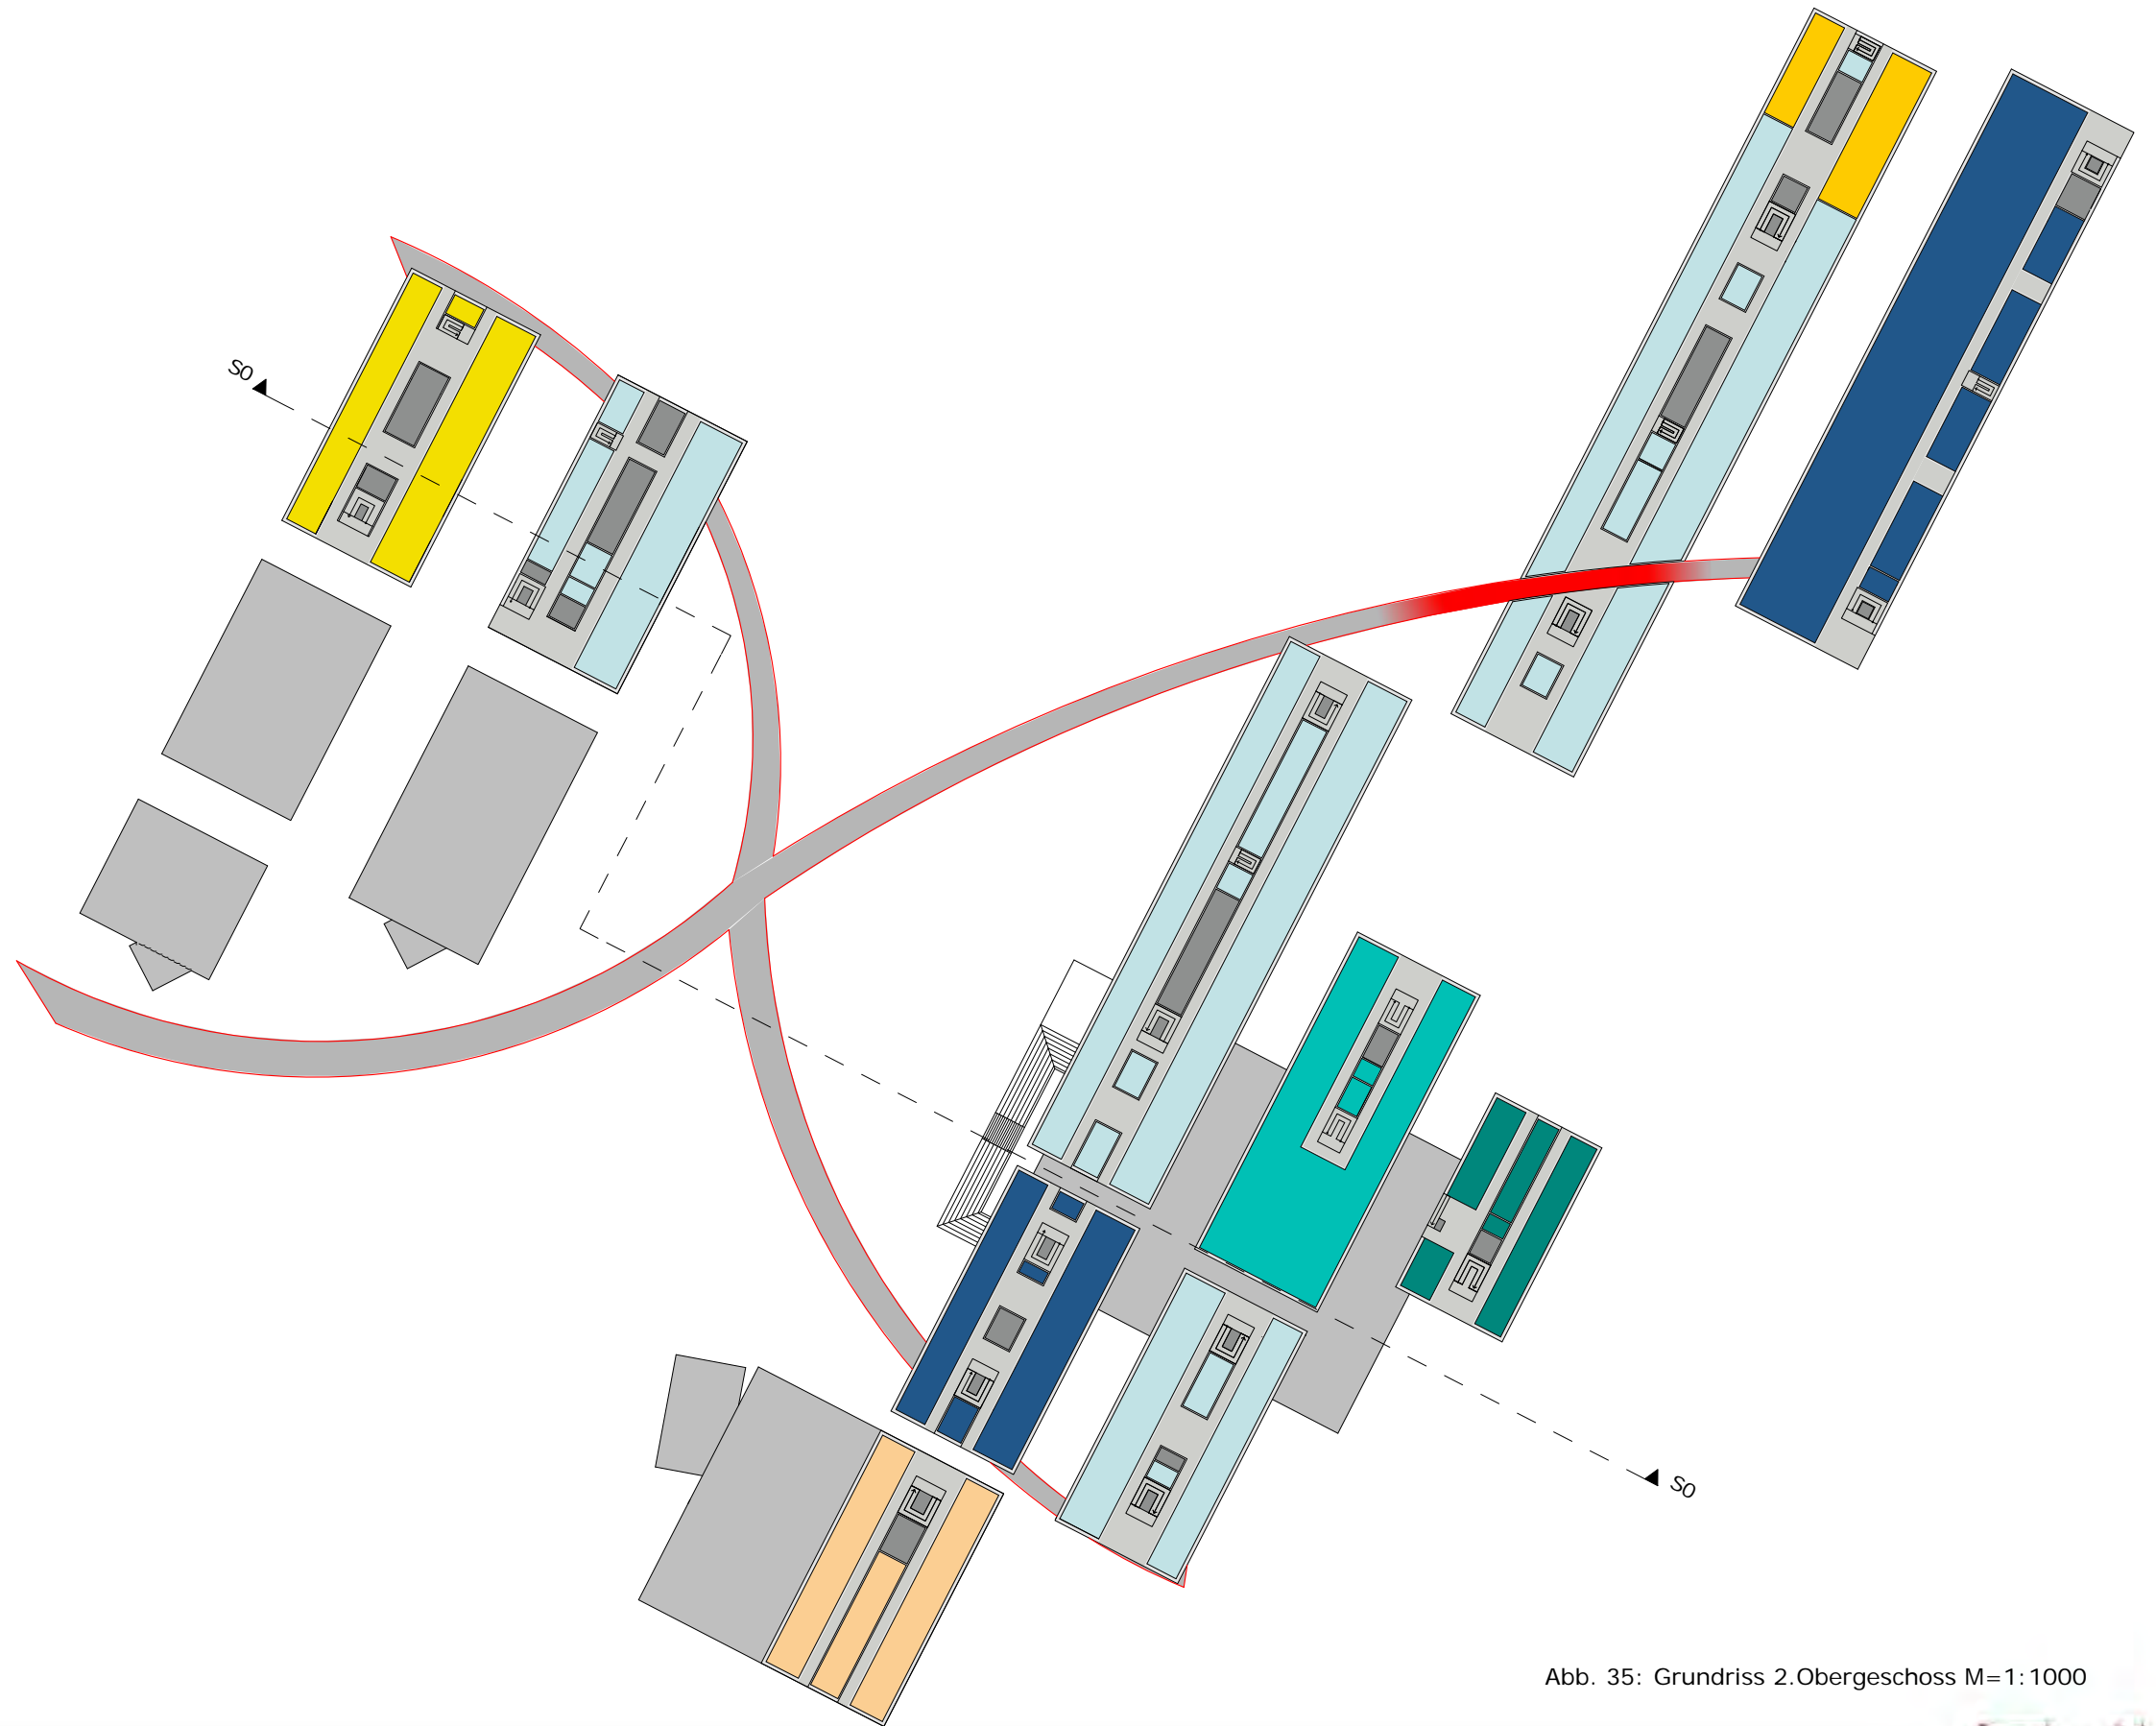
Grundriss 2.Obergeschoss M=1: 1000
